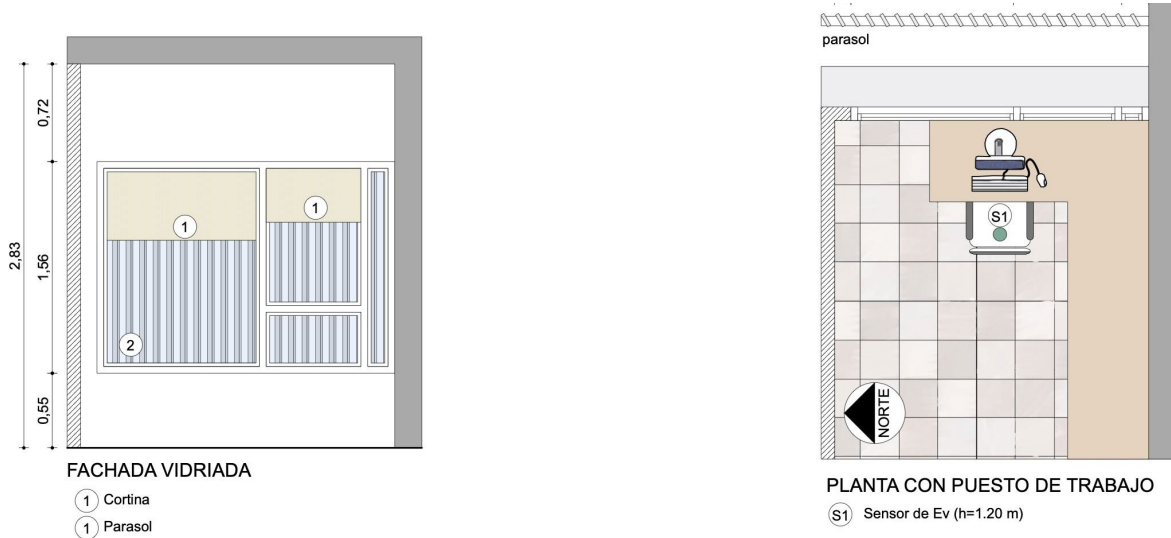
En la fachada vidriada (superior) se observa los dos tipos de elementos de control utilizados y las dimensiones de la ventana. En la planta (inferior) se observa el puesto de trabajo y la ubicación del sensor de iluminancia vertical. Fuente: Elaboración de los autores.
